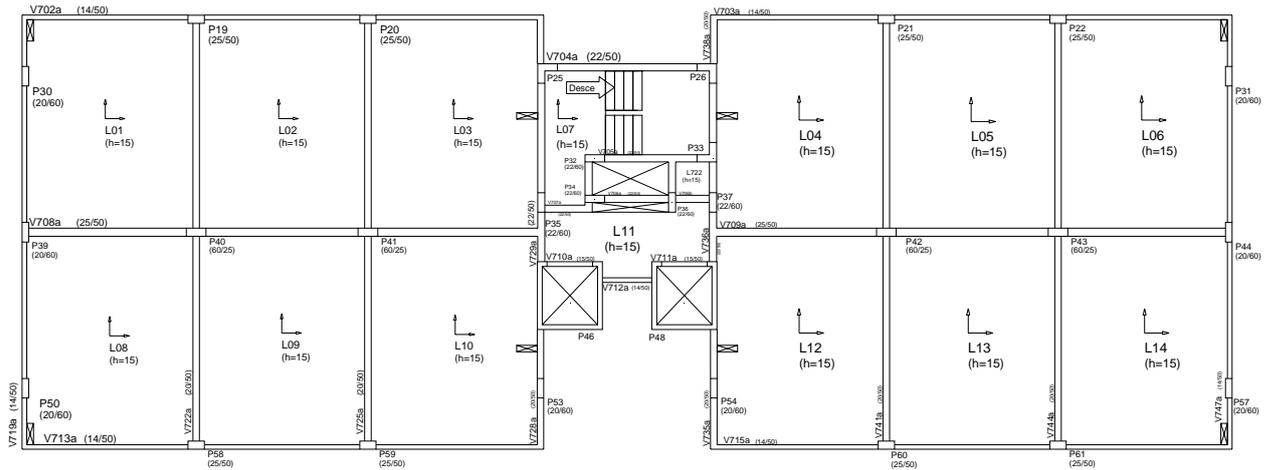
Planta baixa do pavimento tipo do Edifício 02
